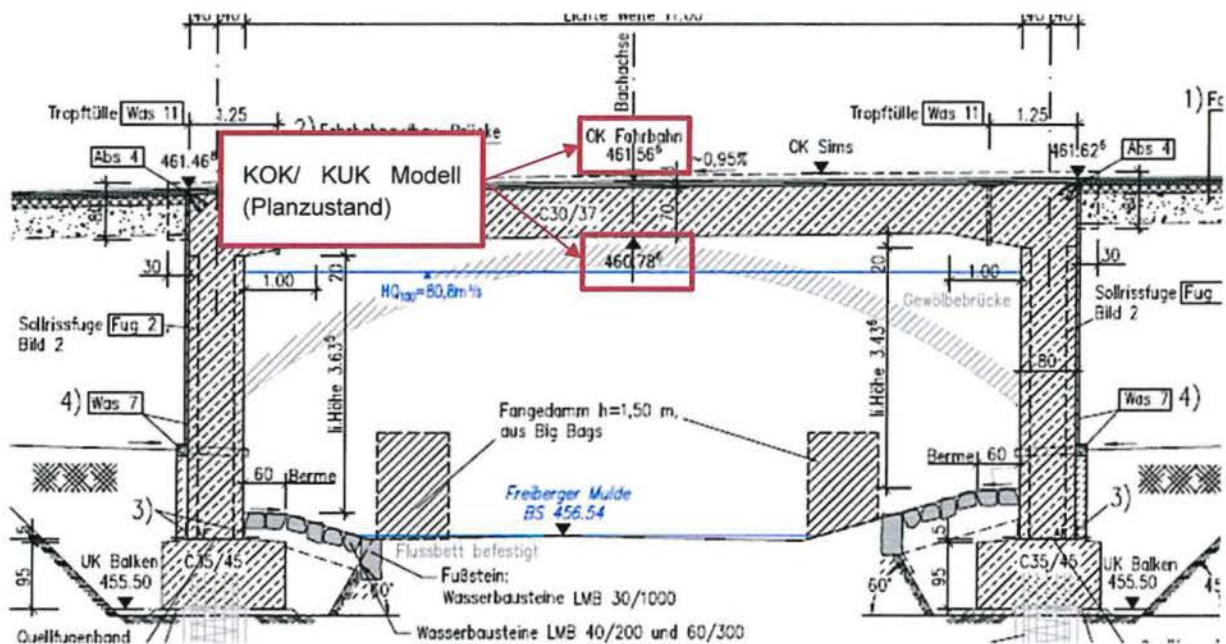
Brückenquerschnitt Fangdämme lt. Planung [g4] Ist- und Planzustand
